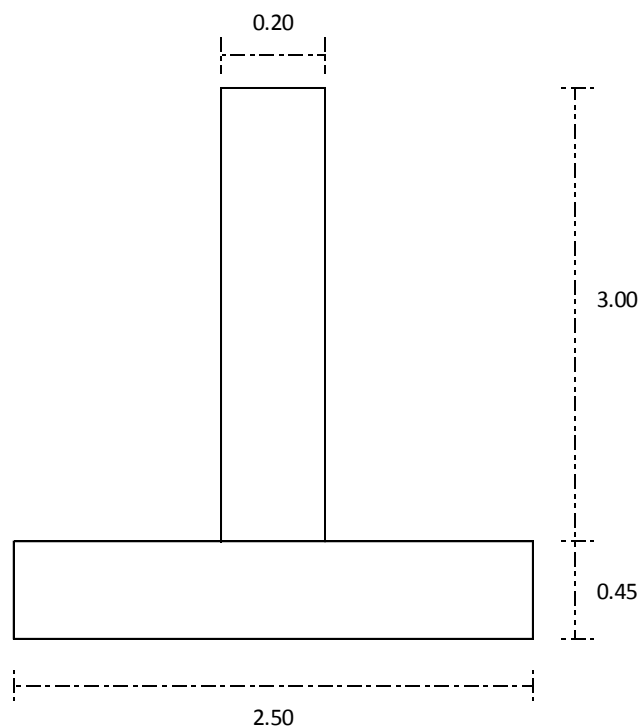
Corte de Muro tipo – Dimensões em metros
